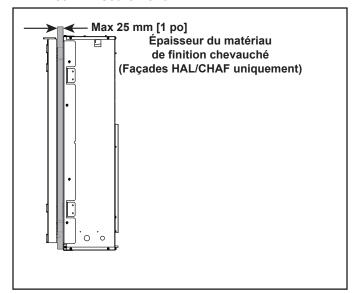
Finition de l'ajustement par chevauchement (les façades CHAF et HAL uniquement)
